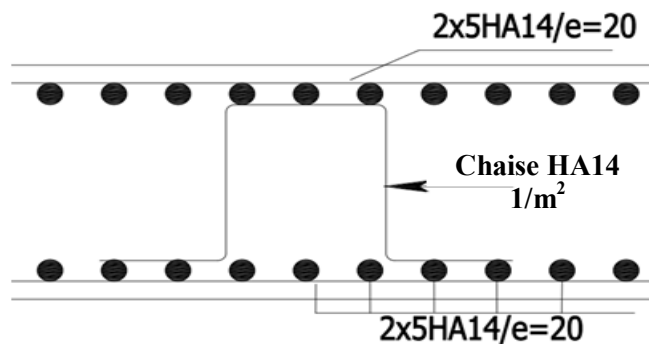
Ferrailage de la dalle du radier (travée + appuie)
